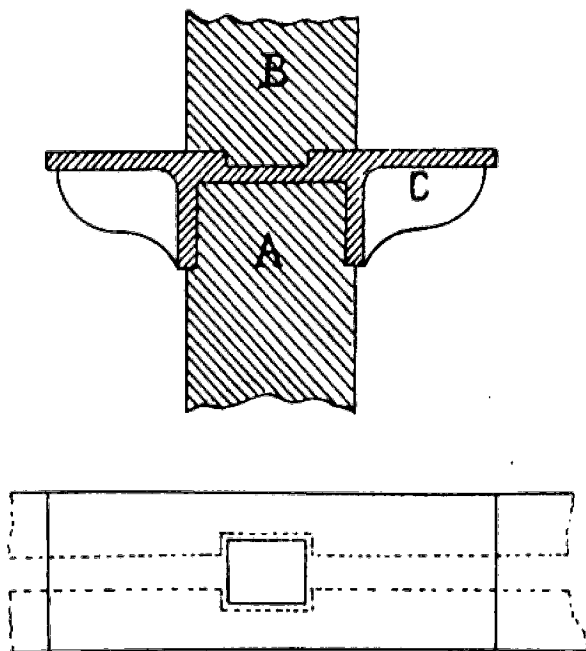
Poteaux superposés reposant les uns sur les autres par l'intermédiaire d'un chapeau en fonte.
